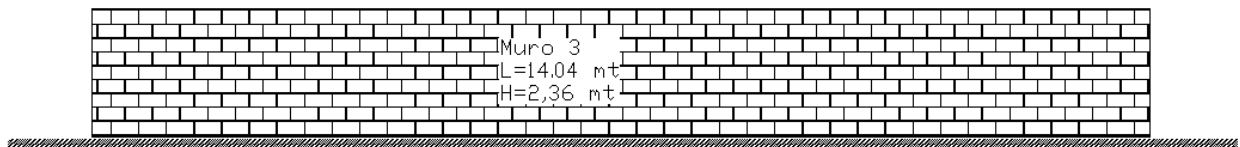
32. Muro Central Eje Y, edificio 4 pisos
